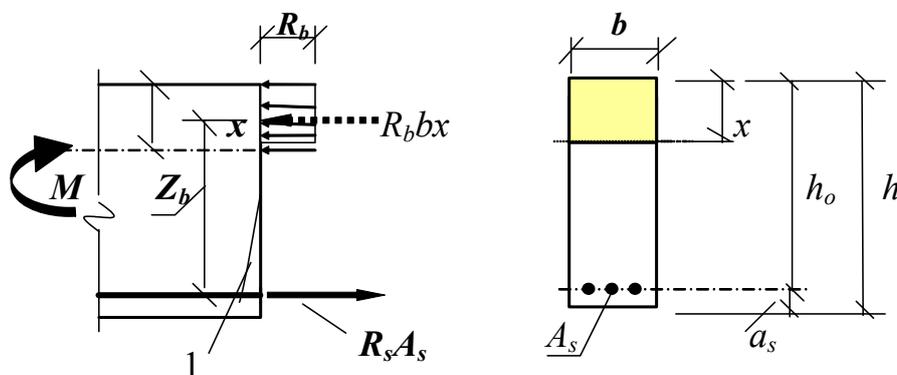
Расчетная схема усилий в нормальном сечении изгибаемого железобетонного элемента прямоугольного профиля при расчете прочности
